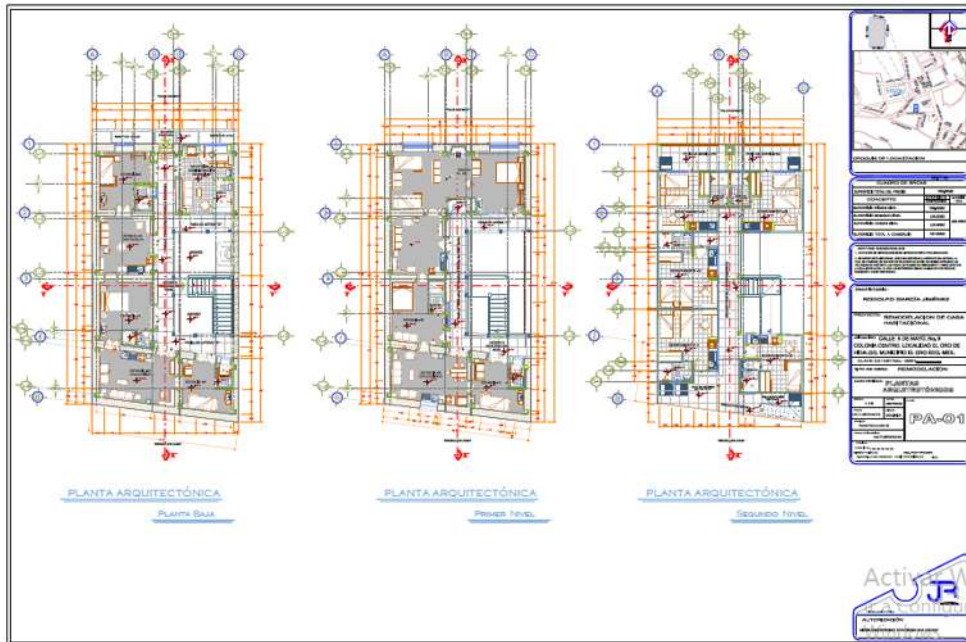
Imágenes del Plano Arquitectónico, donde se especifica el Primer, Segundo y Tercer niveles; en ellas quedan indicado, los ejes de los muros de adobe, como los ejes estructurales de concreto para reforzar la edificación, por el tercer piso que será construido.
